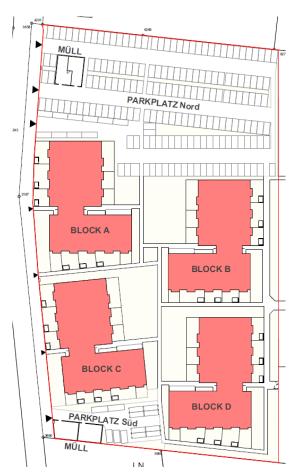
Wohnpark Ober-Grafendorf - Lageplan
